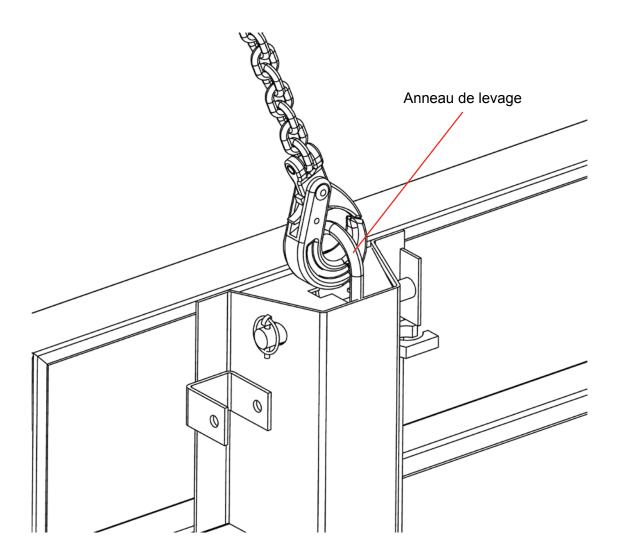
Anneau de levage en partie haute de la banche sur chaque raidisseur
